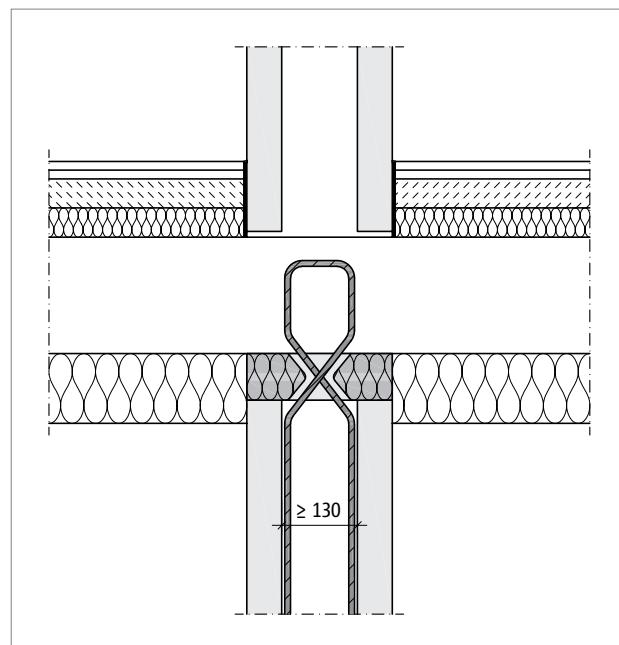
Schöck Sconnex® Typ W: Schematische Darstellung Schöck Sconnex® Typ W bei Doppelwänden und Unterdeckendämmung
